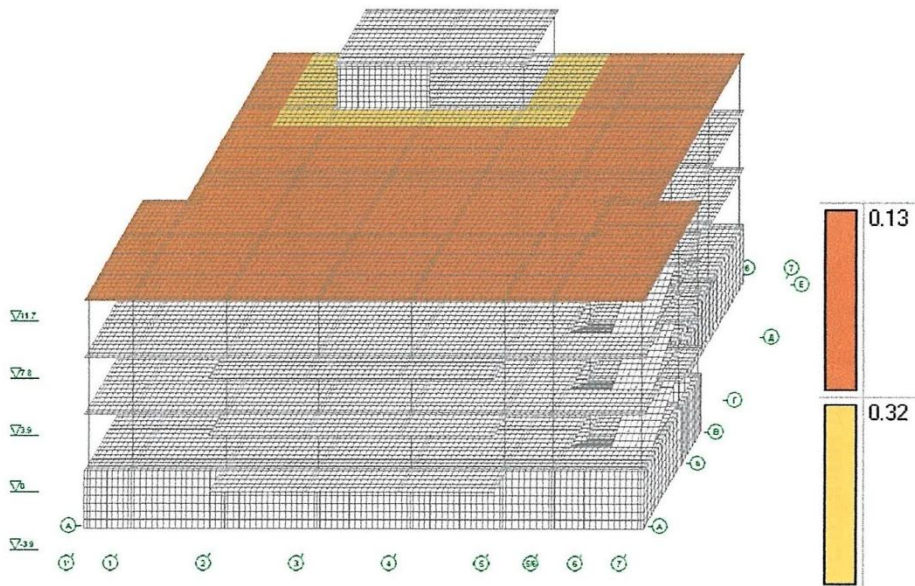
Схема завантаження 4 – Навантаження від снігу 2, т/м<sup>2</sup>
